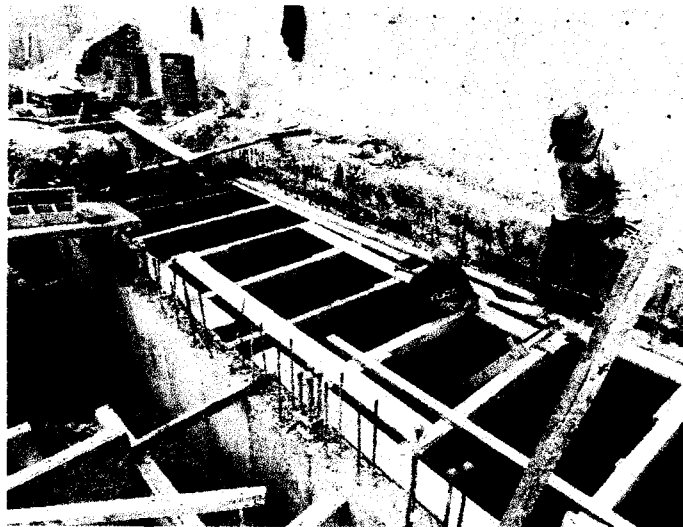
Se realizan los trabajos de encofrado de losa superior del tanque séptico.
